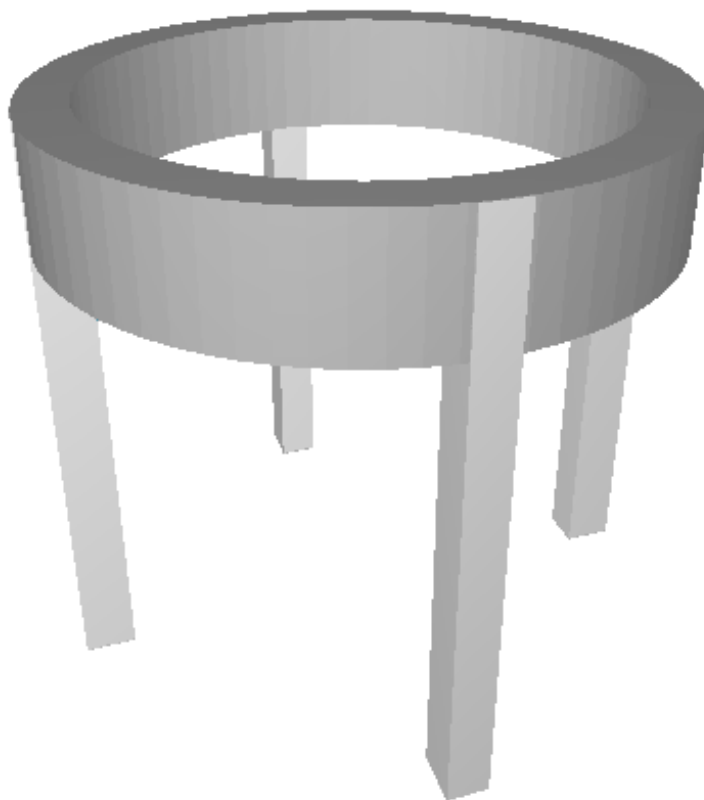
Vista tridimensional do modelo do pedestal de concreto
